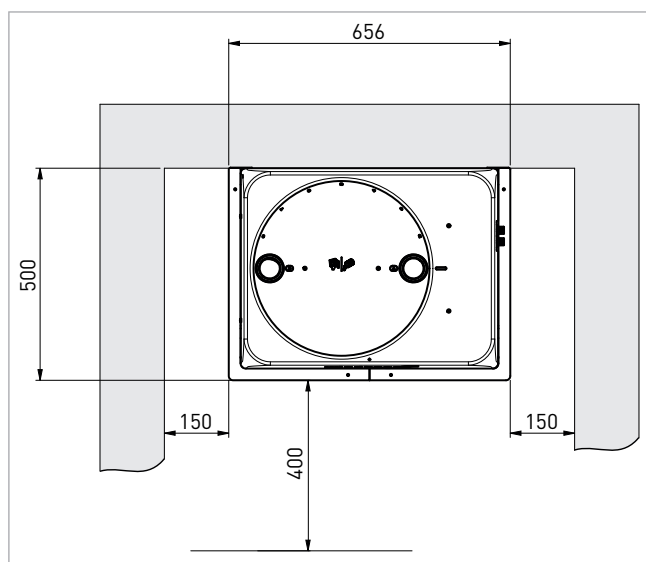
Umschalteinheit, Ansicht von oben (alle Maße in mm)
